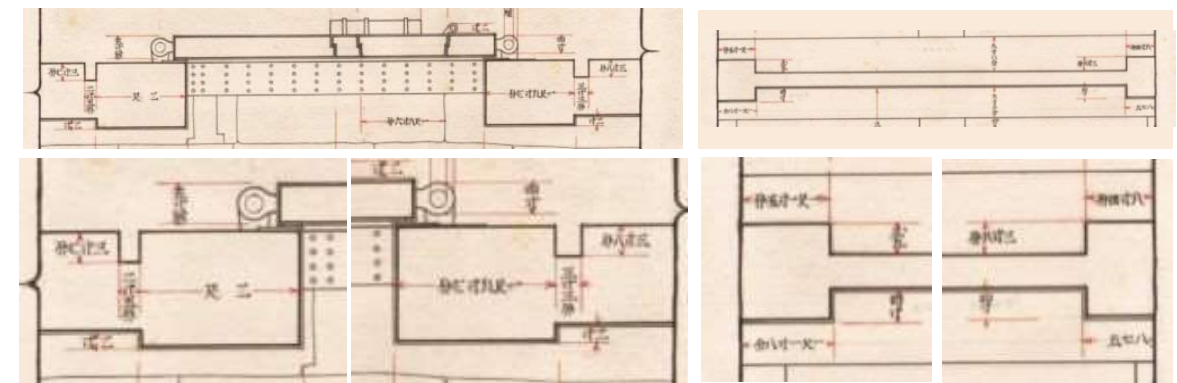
昭和実測図「地階御口御門平面及見上図並断面図」(部分) 地階口御門の冠木上・下の平面詳細図
